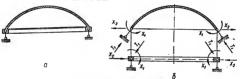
Купольное покрытие? • — расчетная схема; 6 — основная система.
